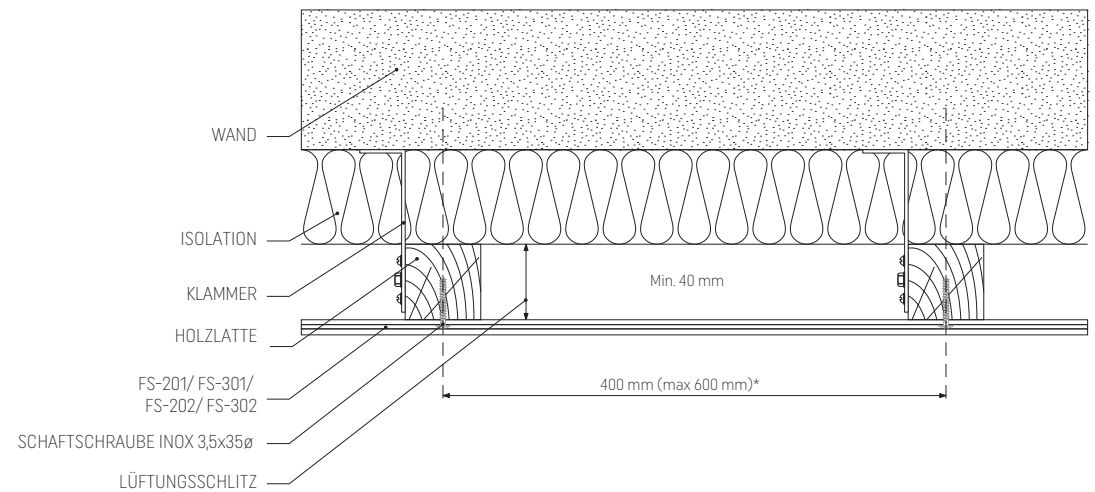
Lüftungsschlitz, bei der Montage an der Mauer mit Isolation und Klammern erforderlich - horizontaler Schnitt
